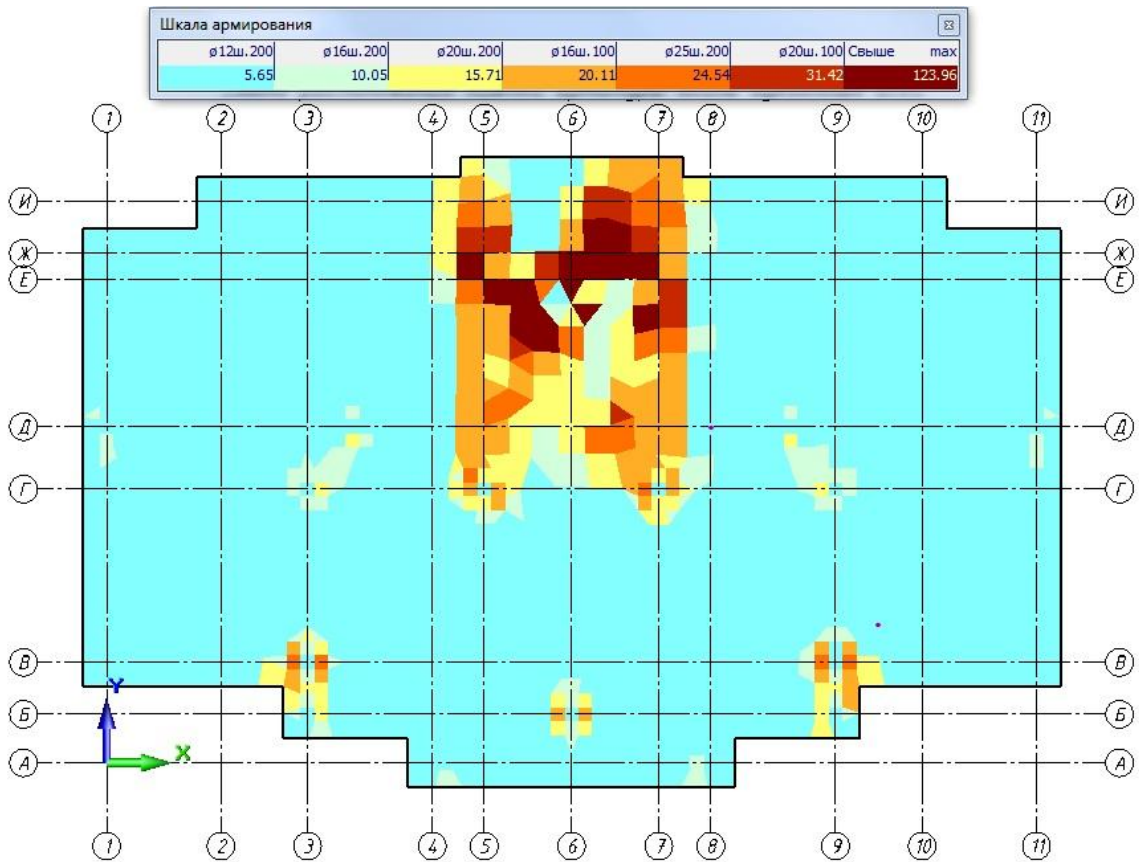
Армування нижньої зони фундаментної плити по осі Y
